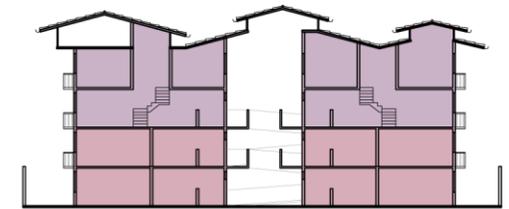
Esquema em corte opção de projeto. Fonte: Elaborado pela autora.
